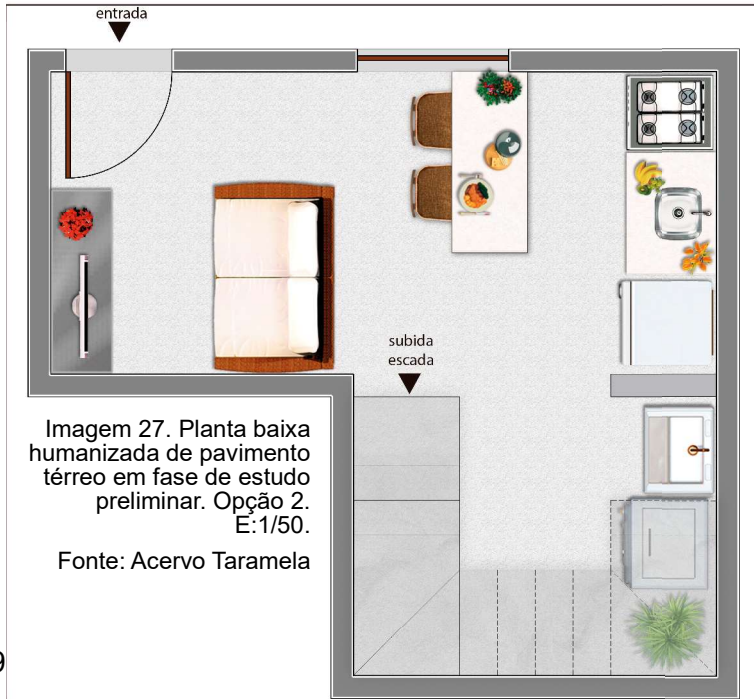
Planta baixa humanizada de pavimento térreo em fase de estudo preliminar. Opção 2. E:1/50. Fonte: Acervo Taramela
